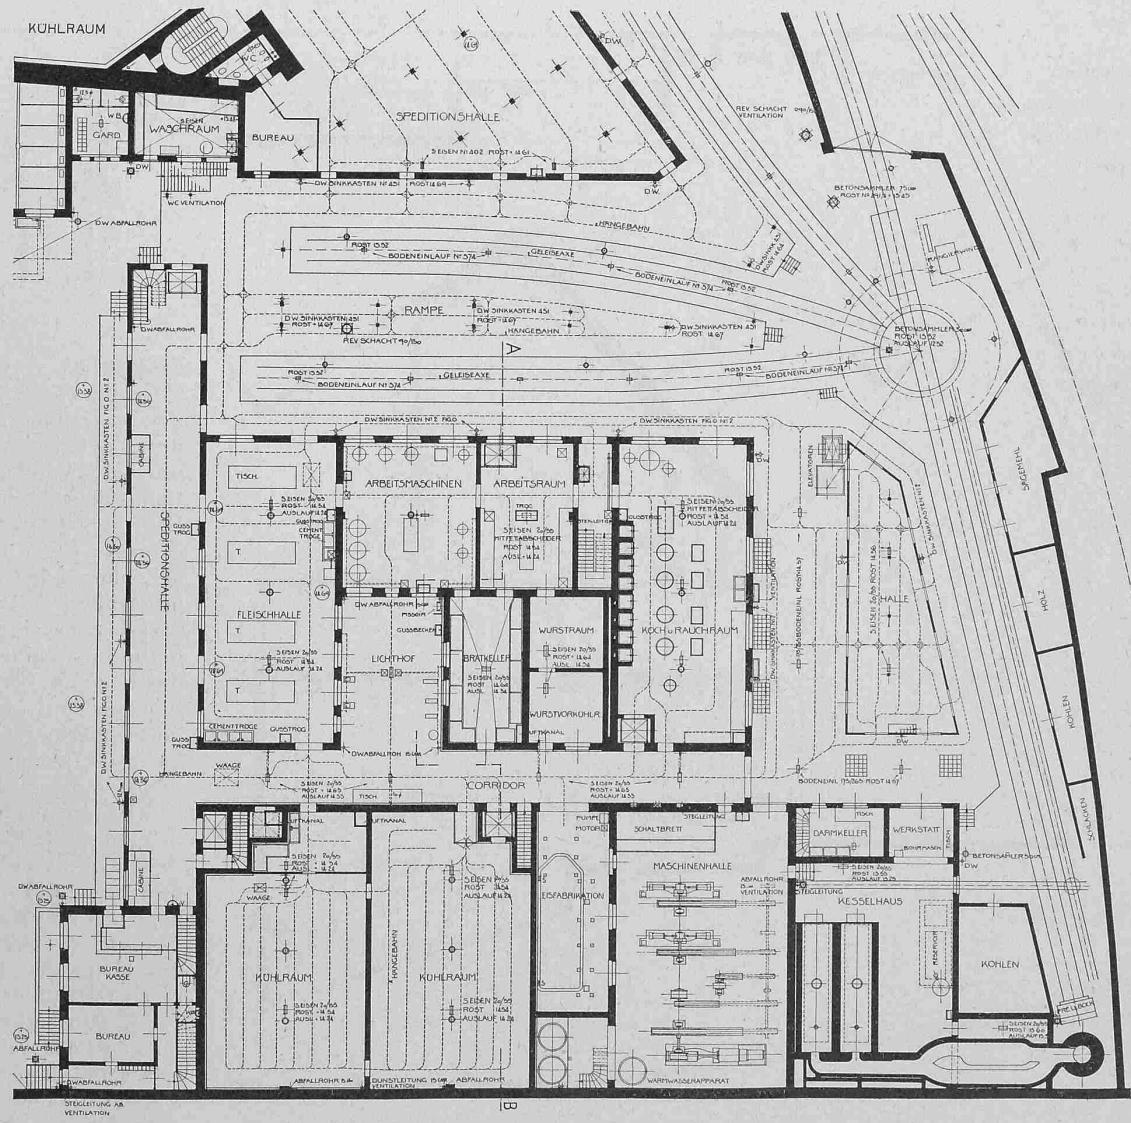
Erdgeschoss-Grundriss der älteren Anlage (rechts in Abb. 1 und 3). — Maßstab 1:500.
